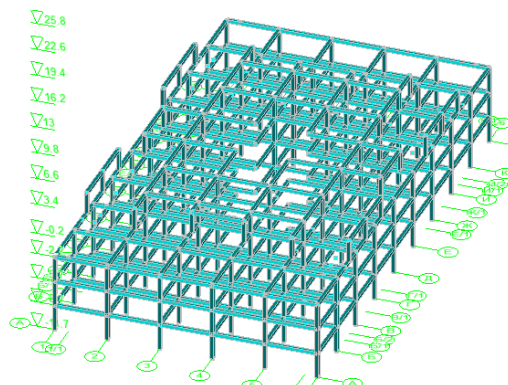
Создание расчетной схемы в Форум (каркас здания)
